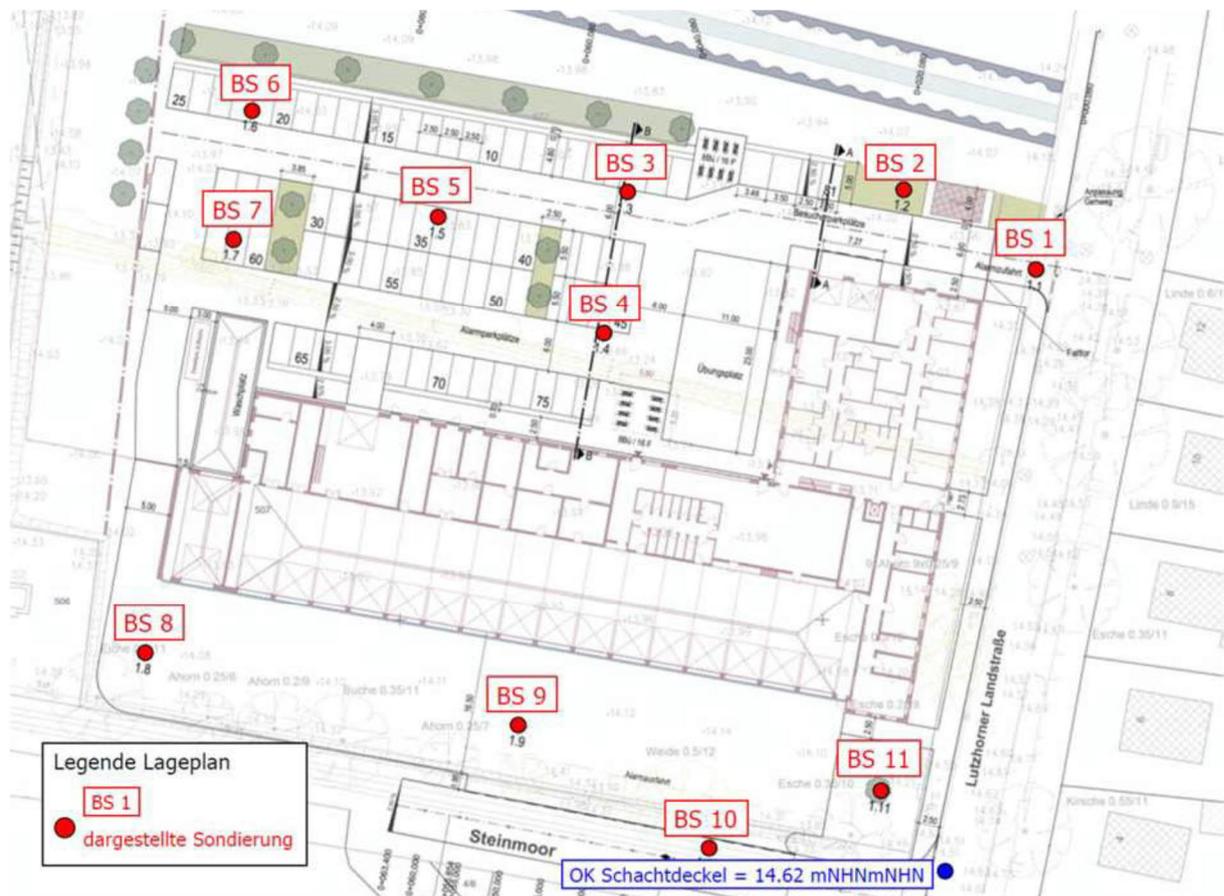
Lage der 2023 durchgeführten Bodensondierungen (aus GSB 2023)
